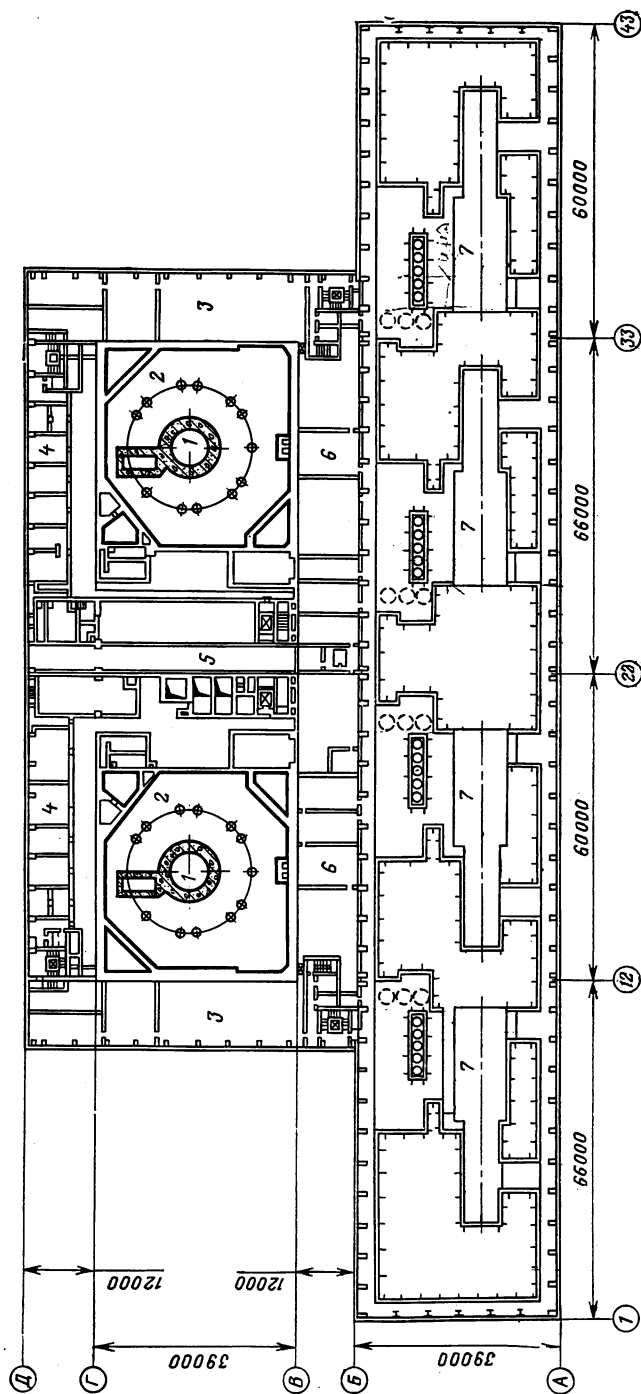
План главного корпуса третьей очереди Нововоронежской АЭС:
